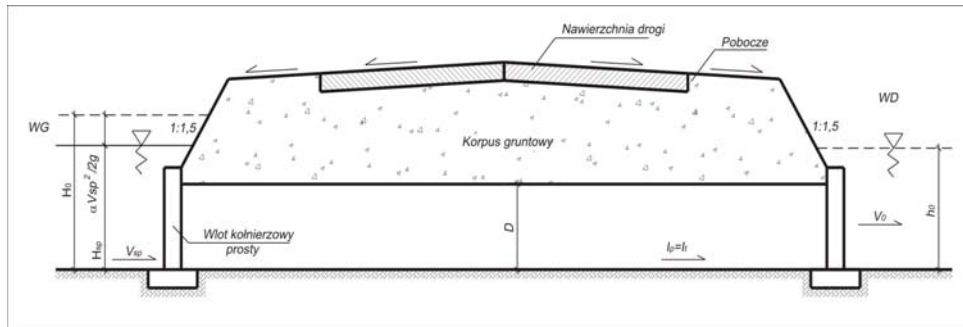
Schemat półciśnieniowej pracy przepustu
